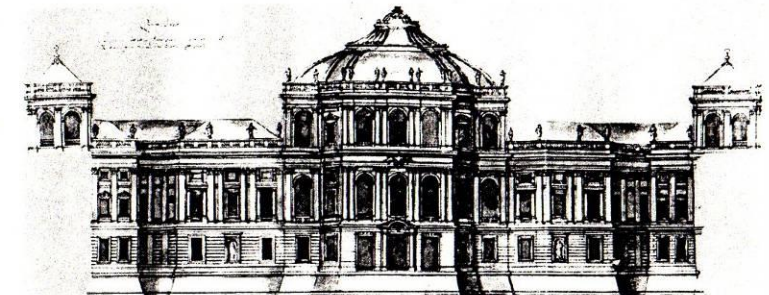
/250. Paris. Le Louvre - Pierre de Cortone - Projet de la façade sur le jardin du Louvre - Musée du Louvre. (Schulz, (7.8)).
